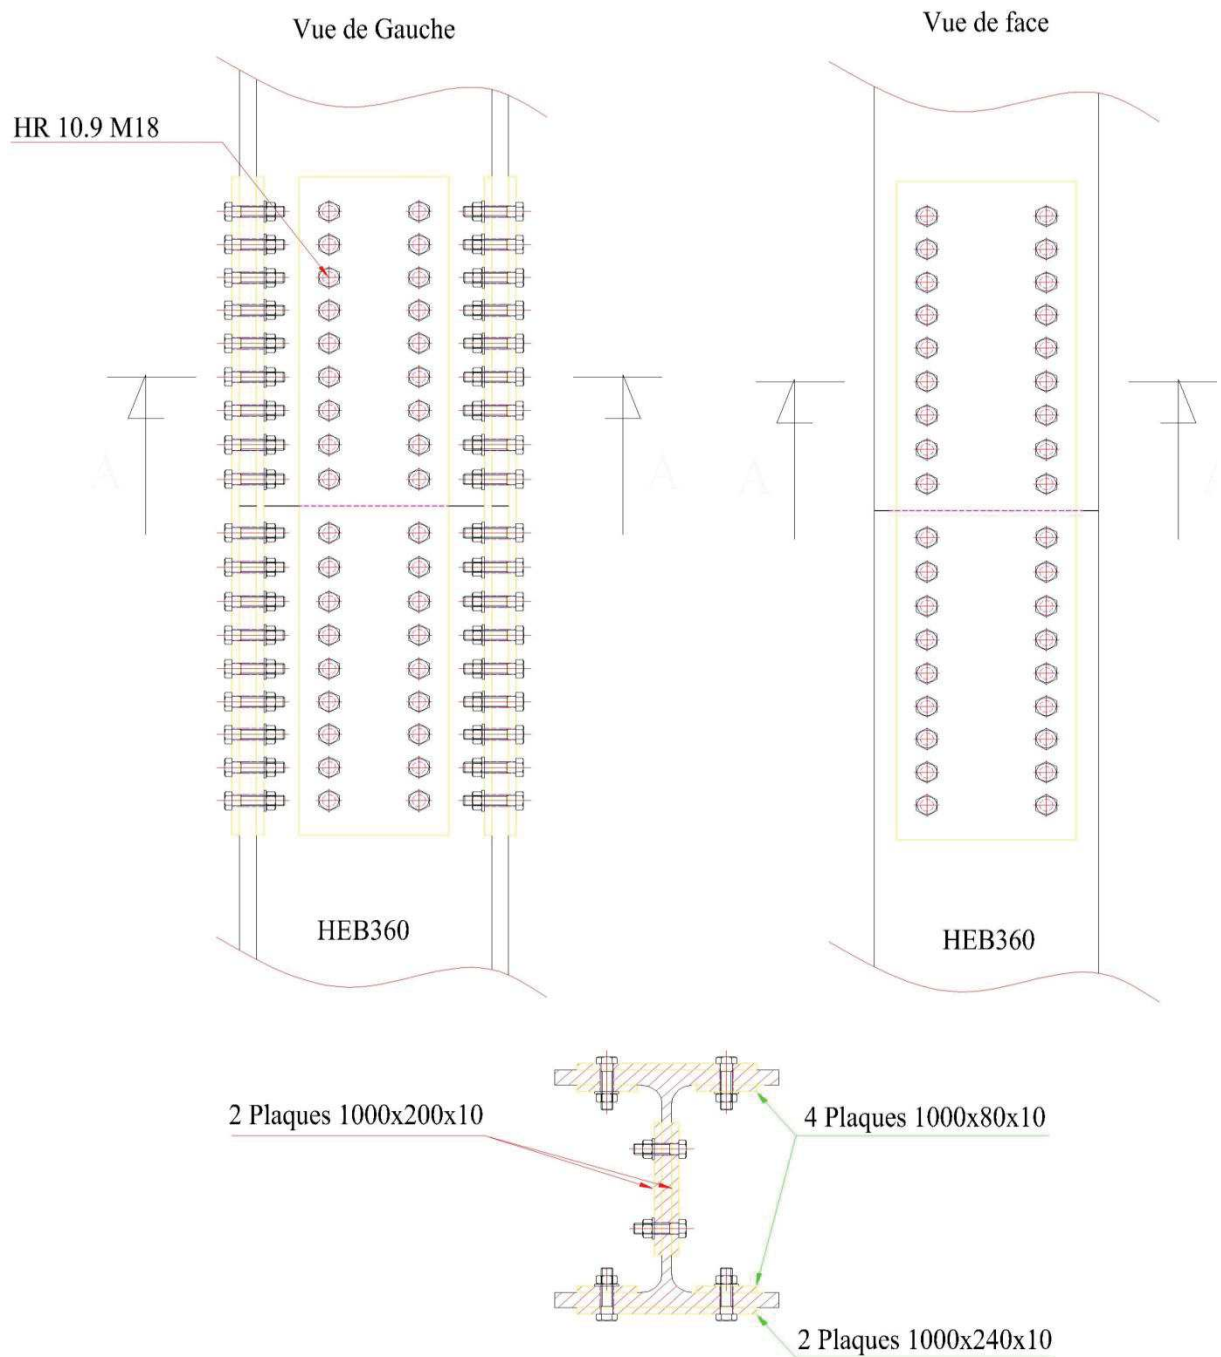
assemblage poteau –poteau (HEB360-HEB360)
